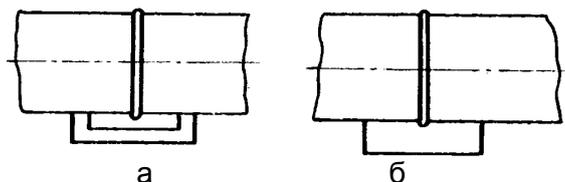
Расположение опор в зоне сварных соединений:
